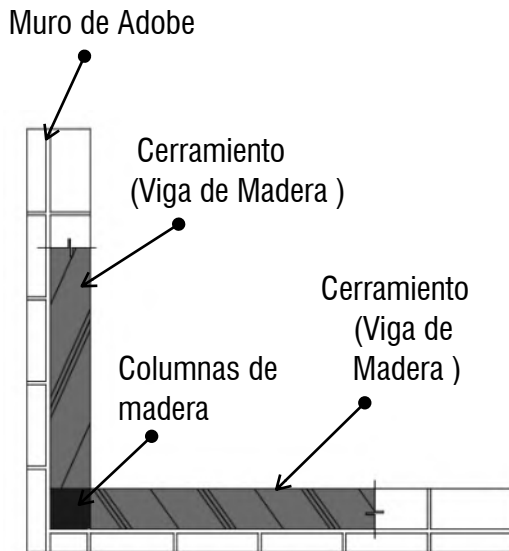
Planta de muro con refuerzos verticales y horizontales
